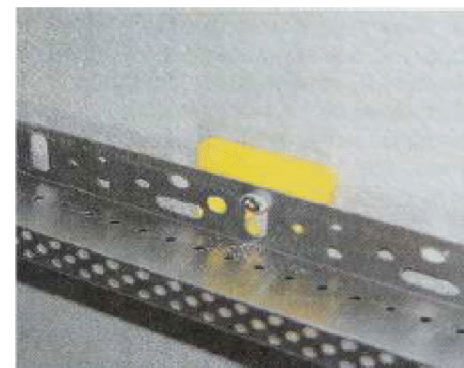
Установка соединительных элементов и подкладочных шайб
